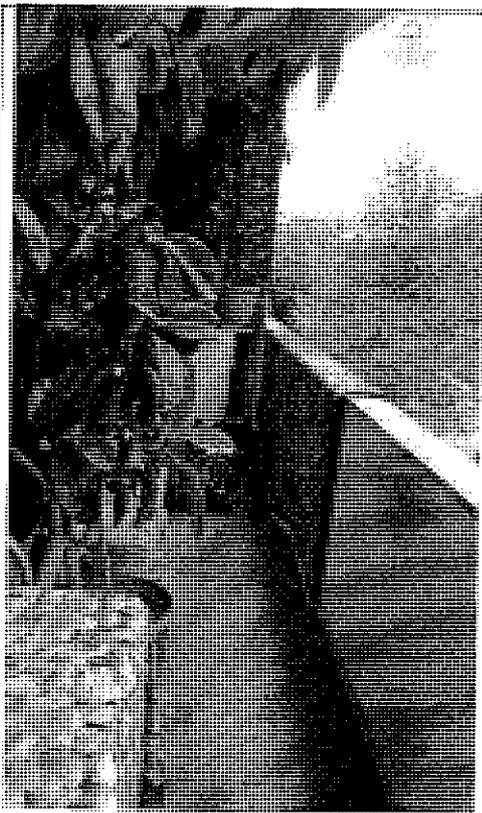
BALCONE SU VIA F. G. FALCONE
